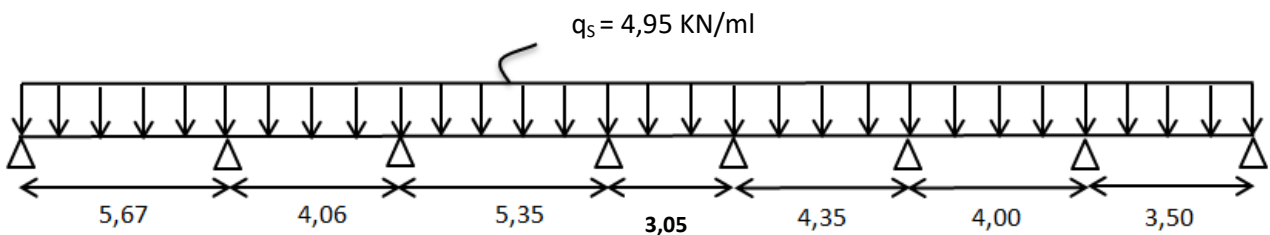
Schéma statique de la poutre continue reposant sur 8 appuis à l'ELS
